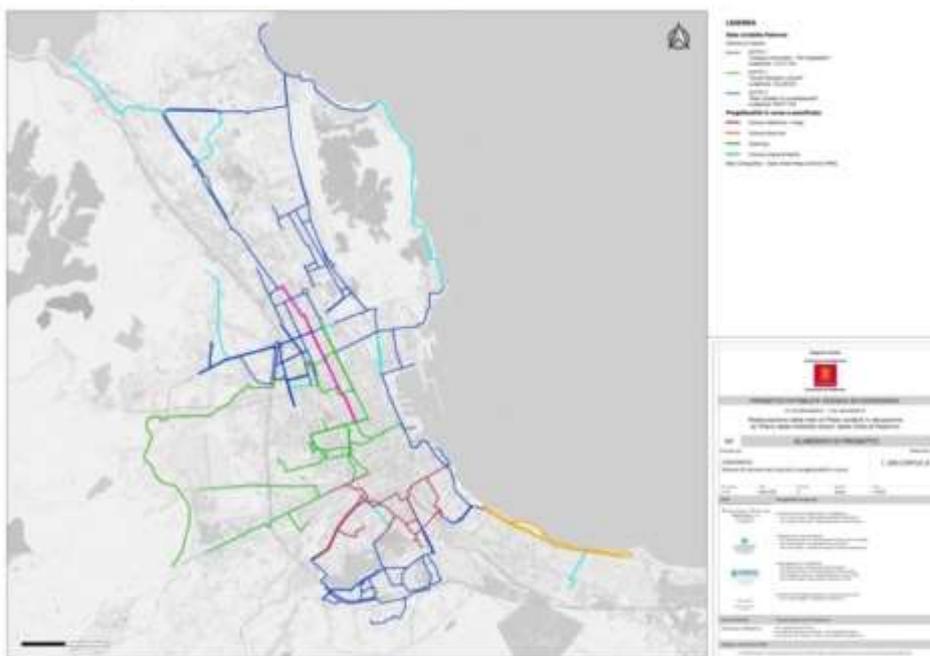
Planimetria Generale del PFTE rete di Piste ciclabili
